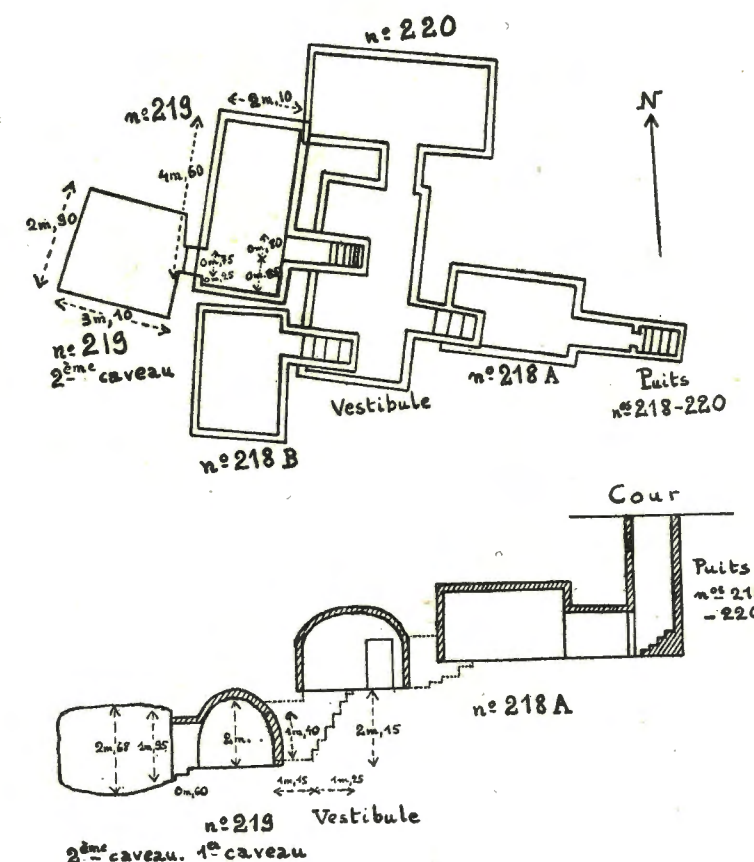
Plan⁽²⁾ et coupe des caveaux n°s 218-219-220.
